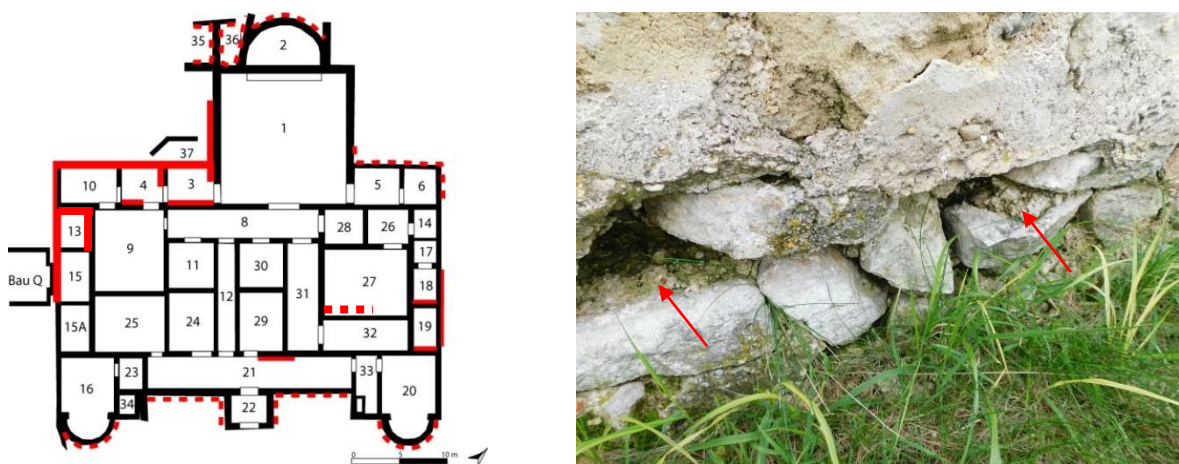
Grundrissplan mit kartierten Fugenfehlstellen.
